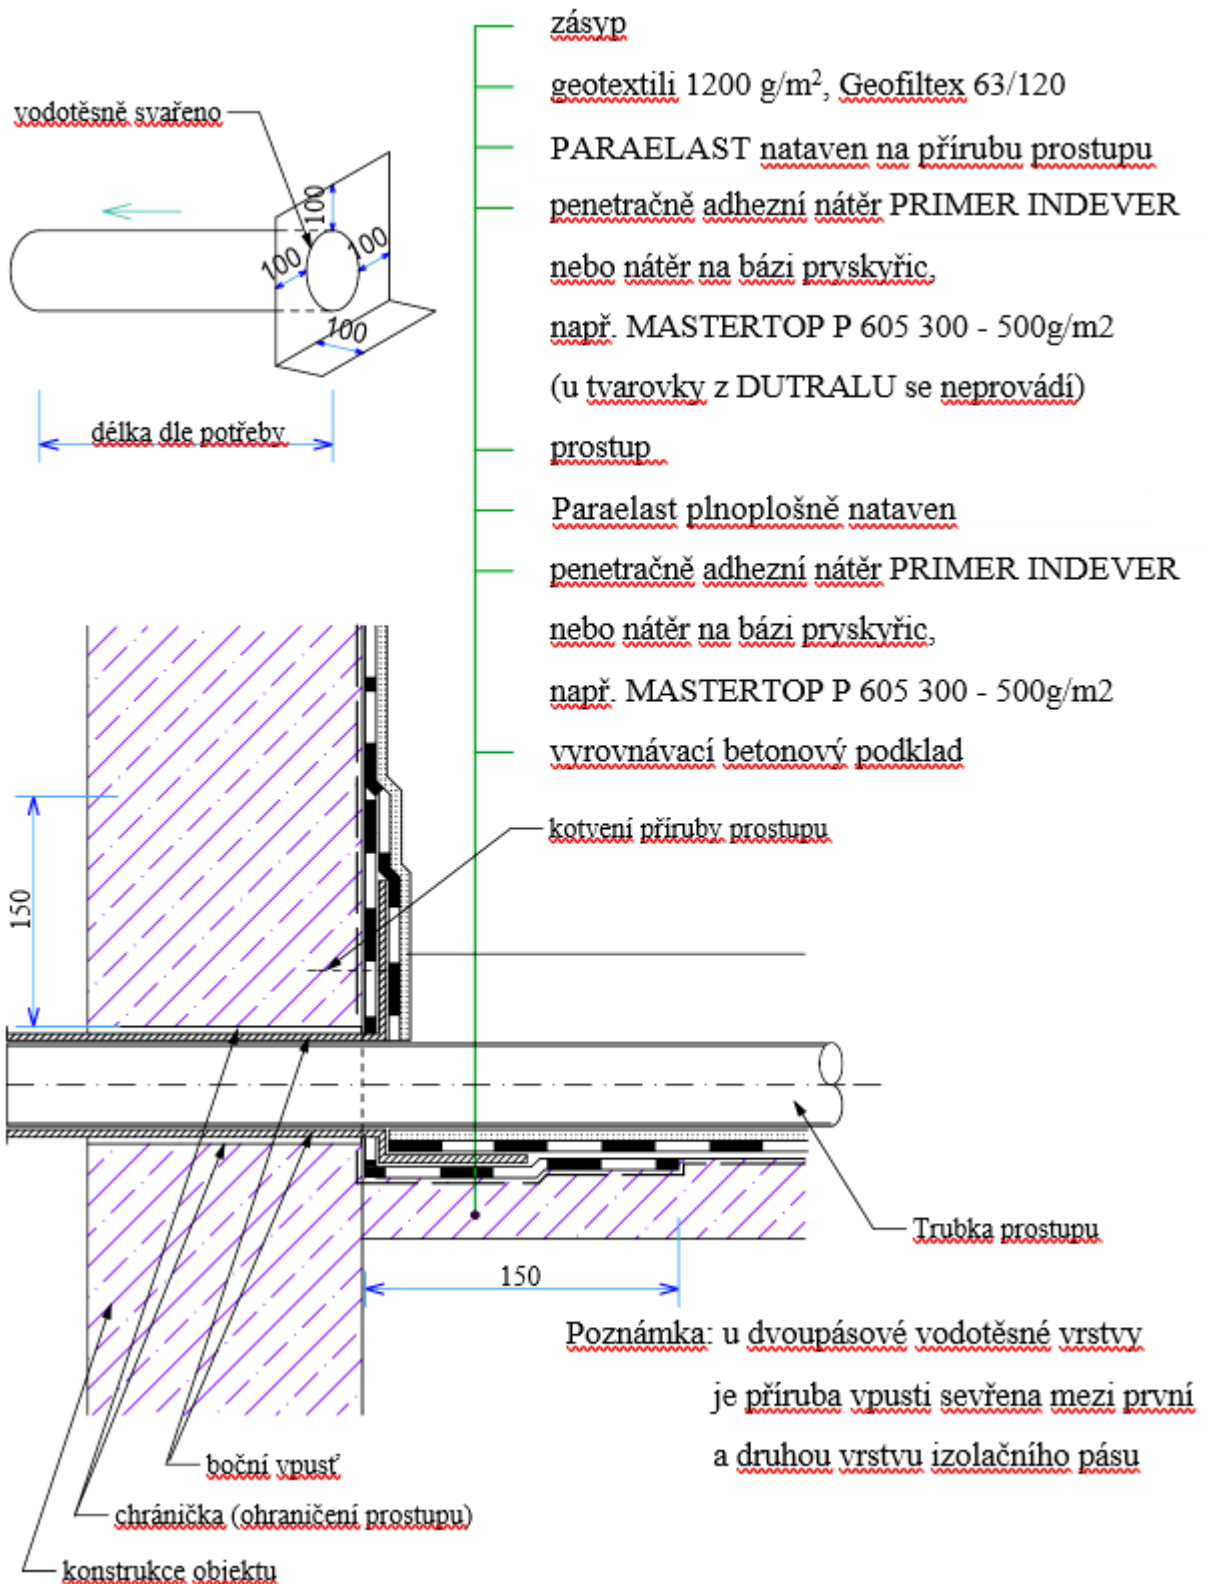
Detail provedení svislé konstrukce s ochrannou vrstvou [5]
